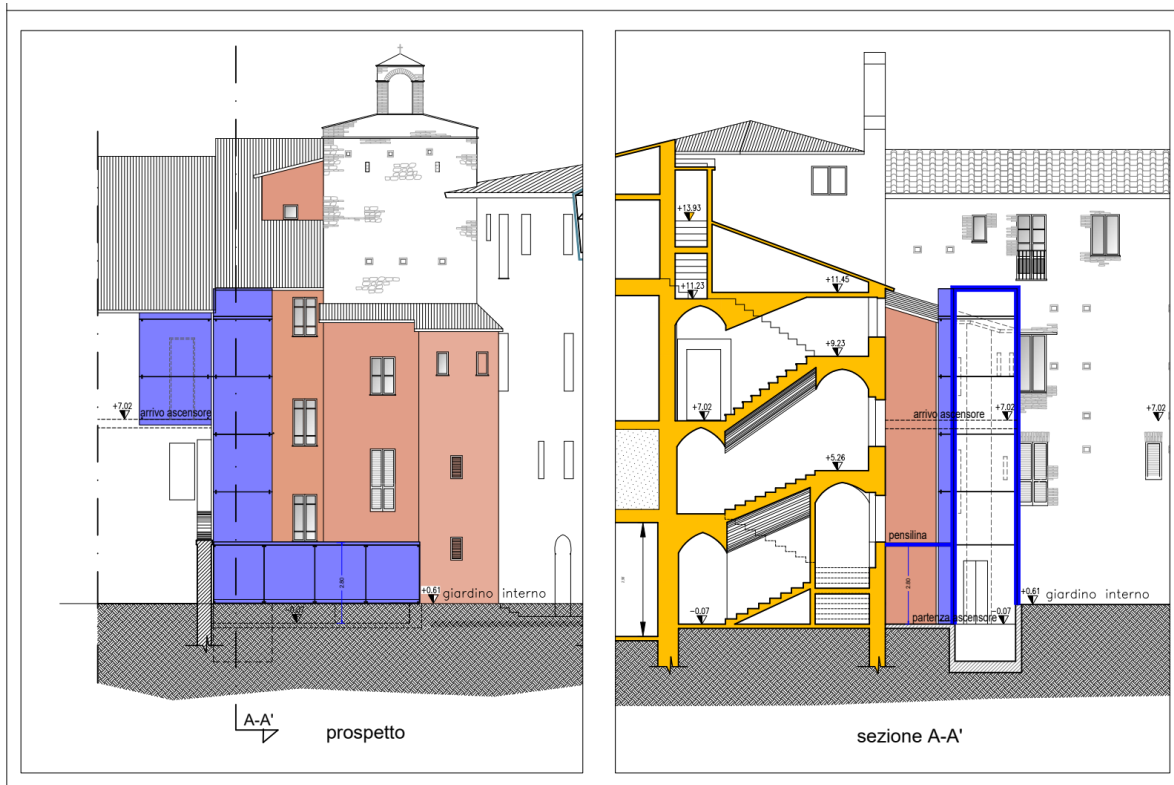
La zona che ospiterà il vano ascensore ed il collegamento con l'androne
